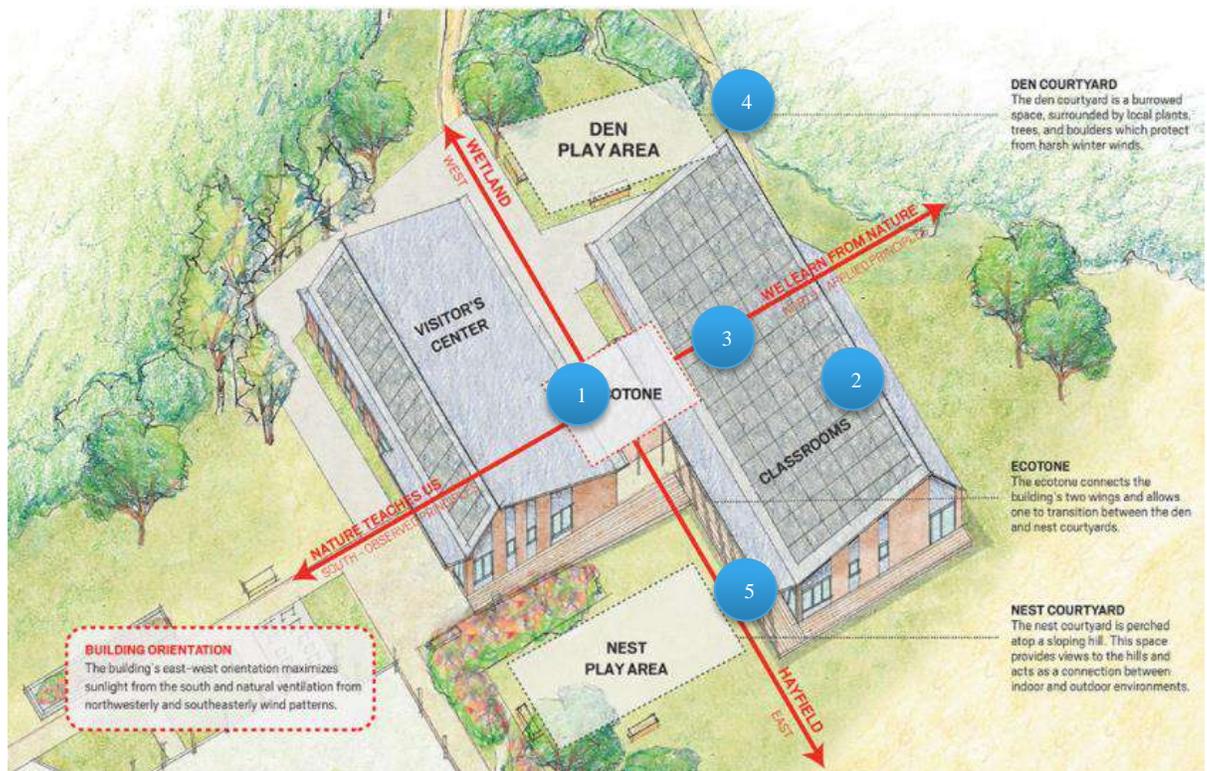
Planta Hitchcock Center (Design Awards, s/f).
